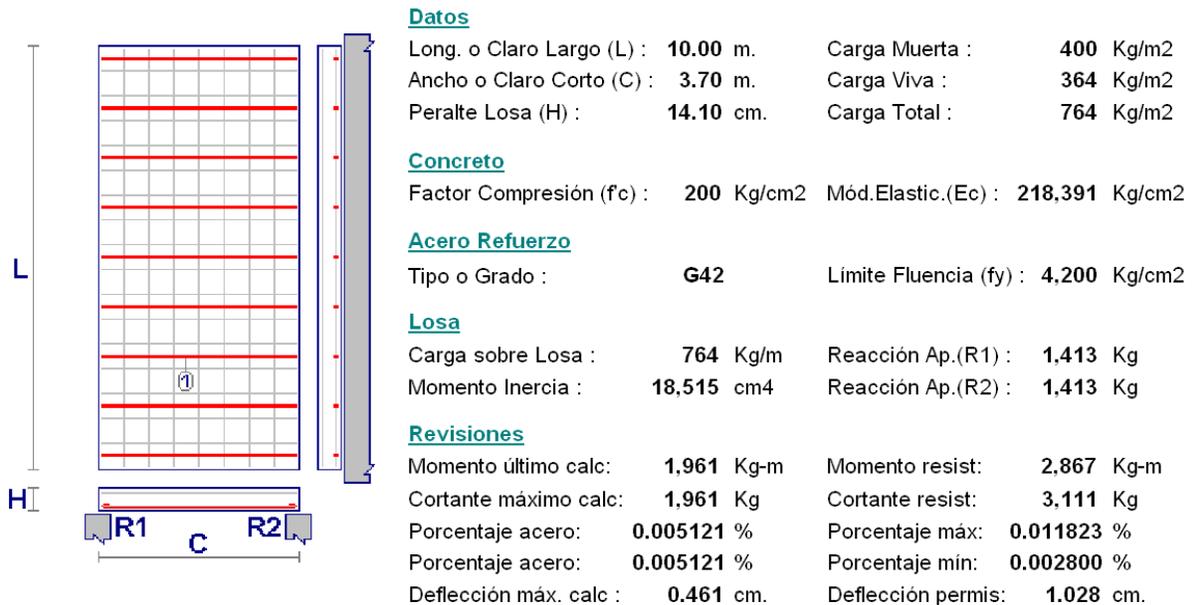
Vista Parcial del Reporte de Losa Panel W.
